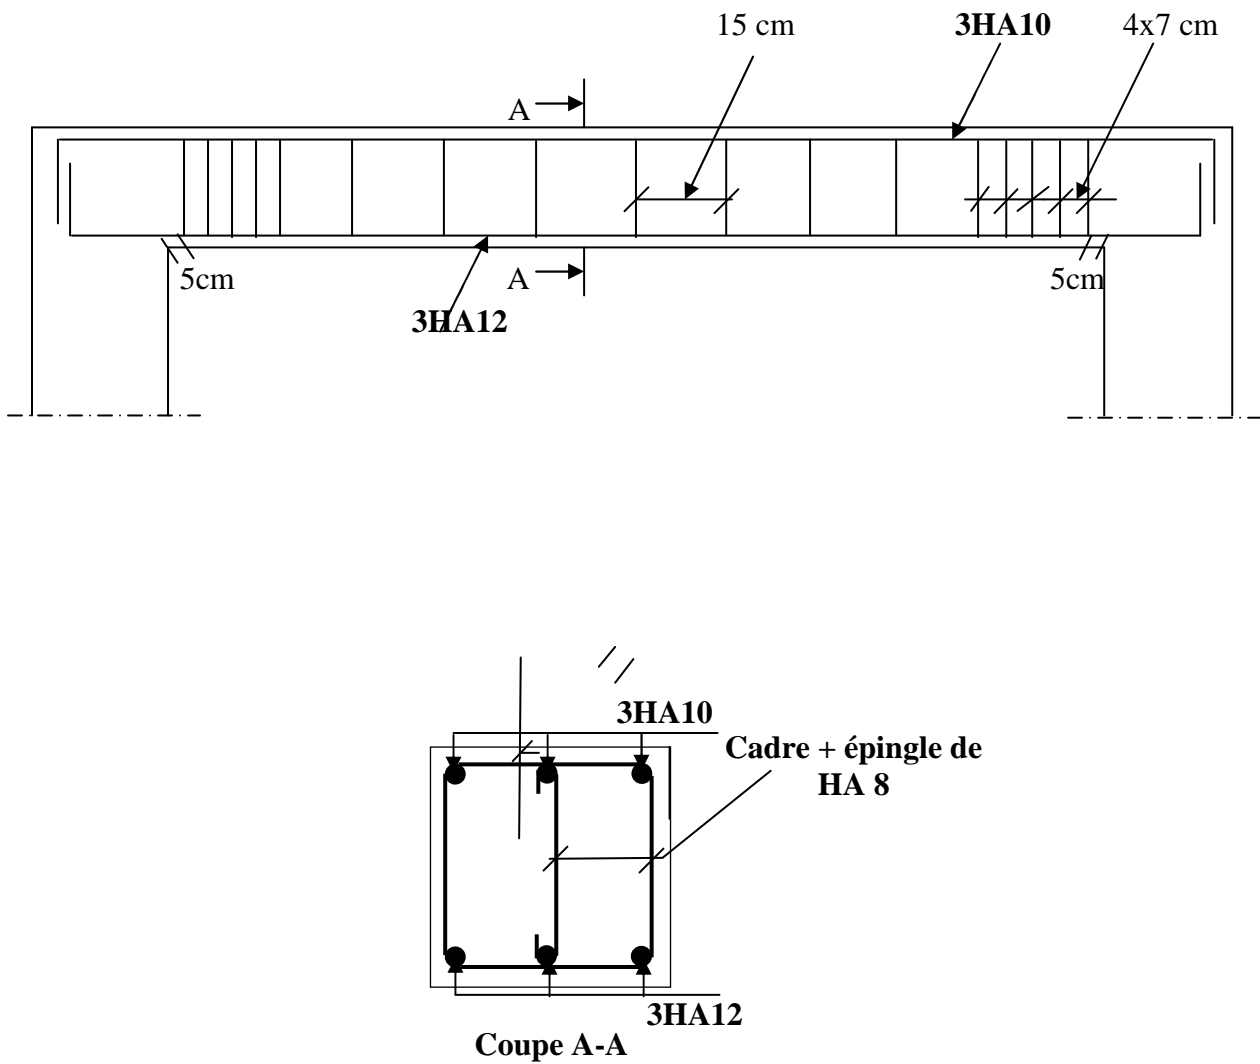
Ferrailage de la poutre de chaînage
